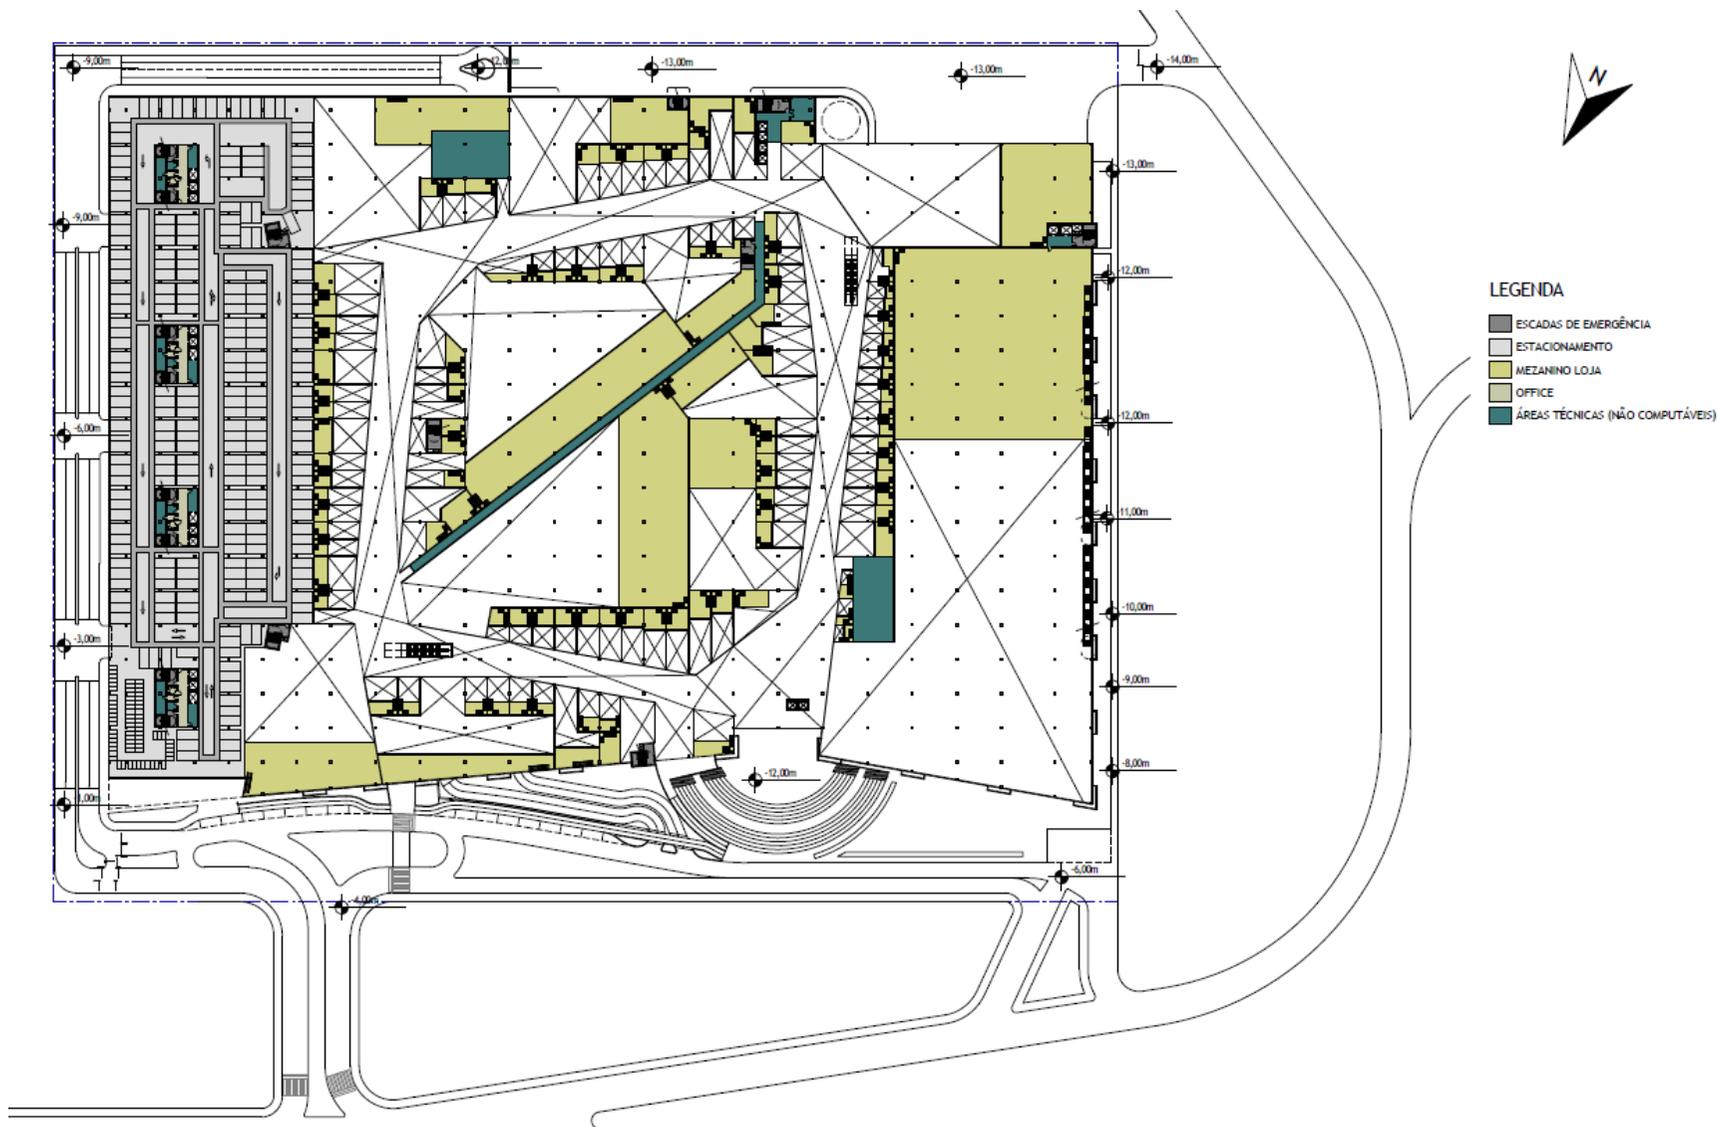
Planta baixa - 1 Semi-enterrado (G4), Nível -3,00m
